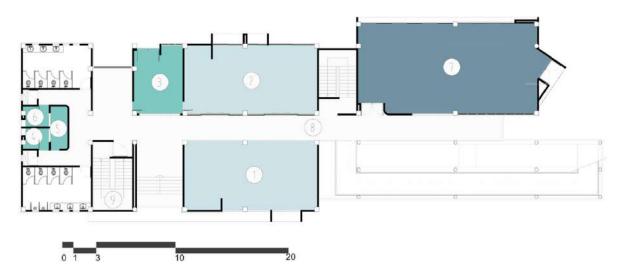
Planta 1 Bloque 54. Fuente: Equipo de diagnóstico.
